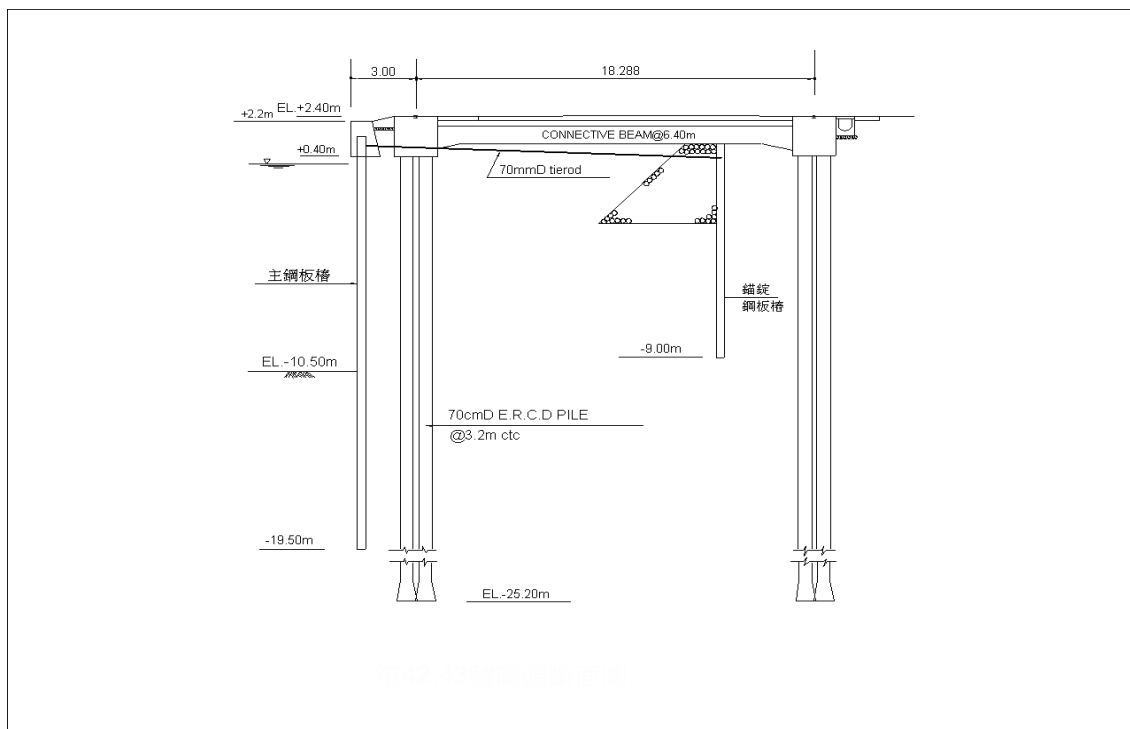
施工因素造成之非標準型板樁式碼頭斷面
